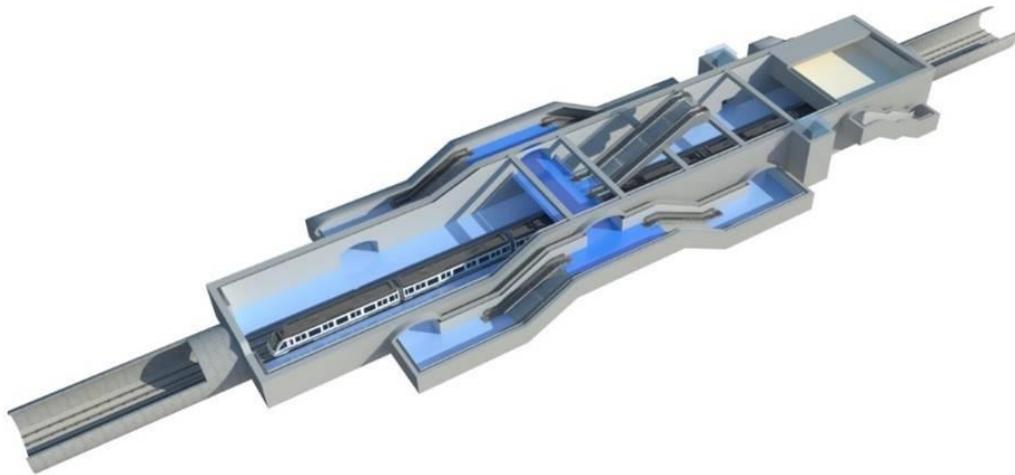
Vistas 3D de la planta de andén y vestíbulo de la estación de la Magdalena.
